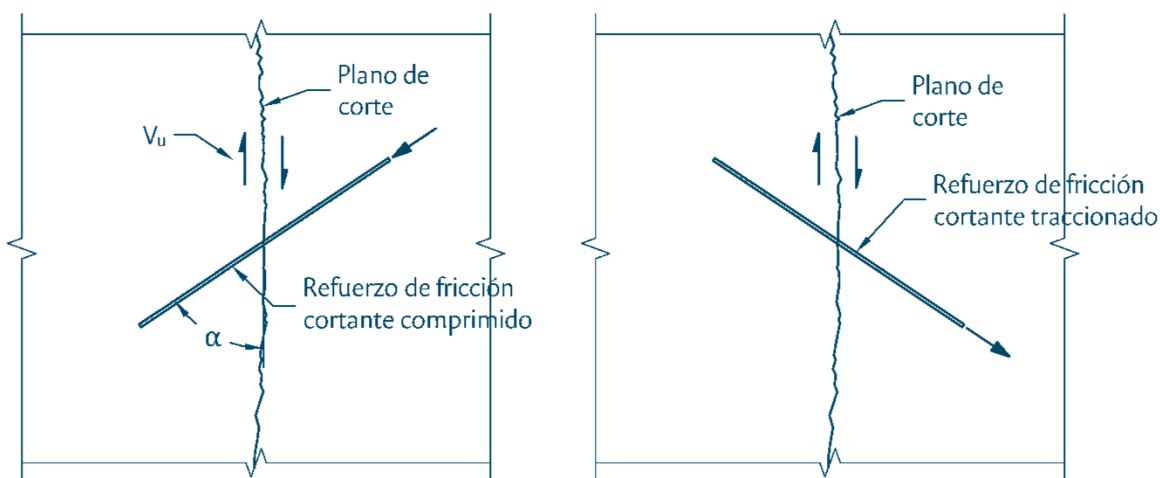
Dovelas inclinadas respecto del plano de corte. Referencia: 5.6.13.8.
